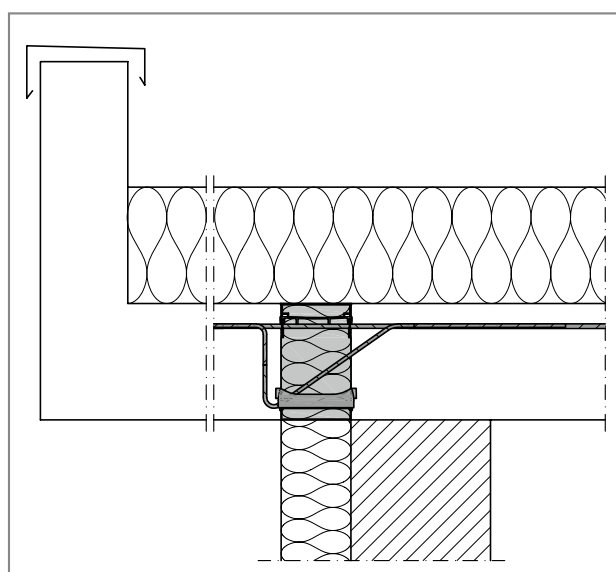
Schöck Isokorb® T type K: Aansluiting bij enkelwandig metselwerk
